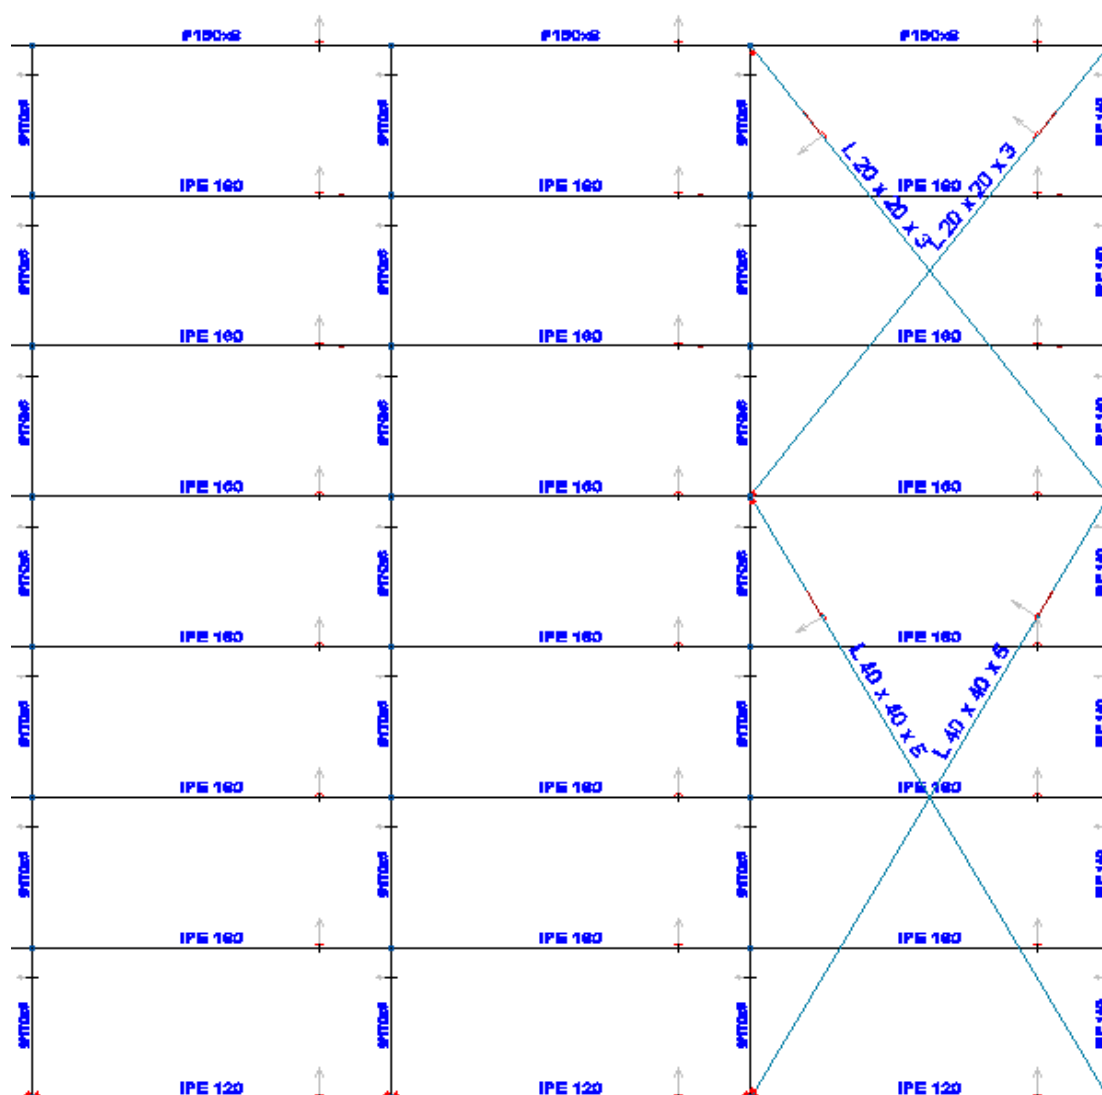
Plano de cubierta izquierda. El perfil de la derecha se corresponde con el pórtico de fachada delantera.
